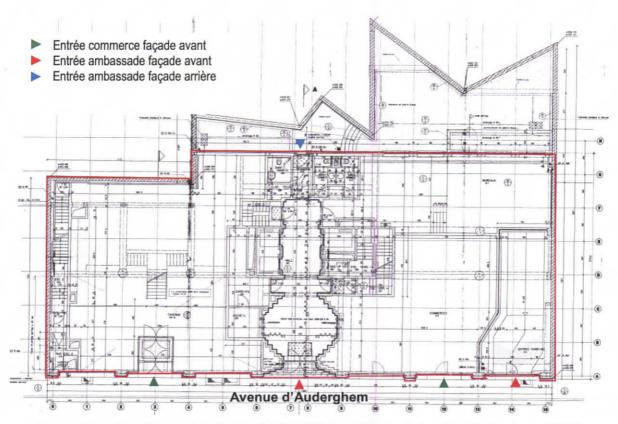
Plan du rez-de-chaussée (ARIES sur plan J. Galand et P. Becker, 1994)
